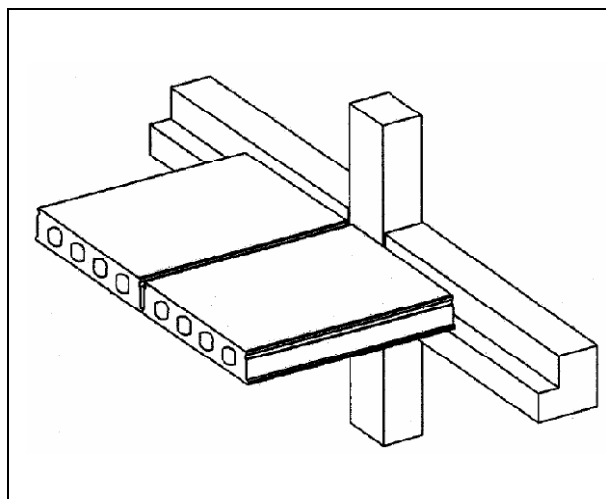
Ligação de lajes alveolares simplesmente apoiadas, em viga “L”, com junta seca, perpendiculares à laje de piso (Arnold, 2002)
